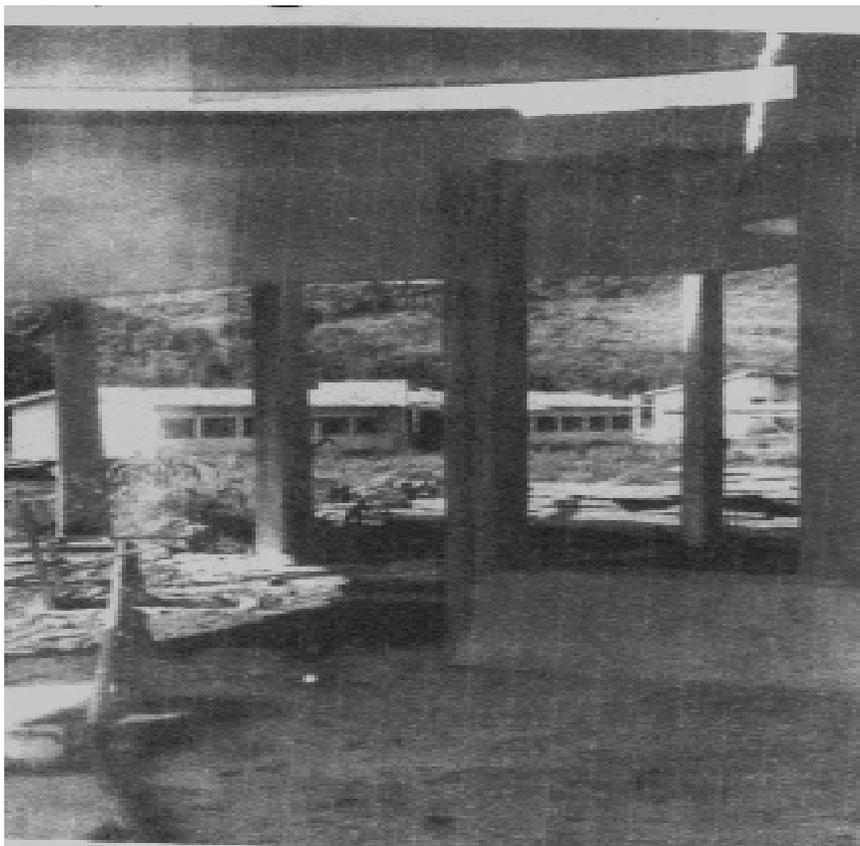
Foto da obra em construção cedida pelo autor, Dr. Romeu P. da Costa.
